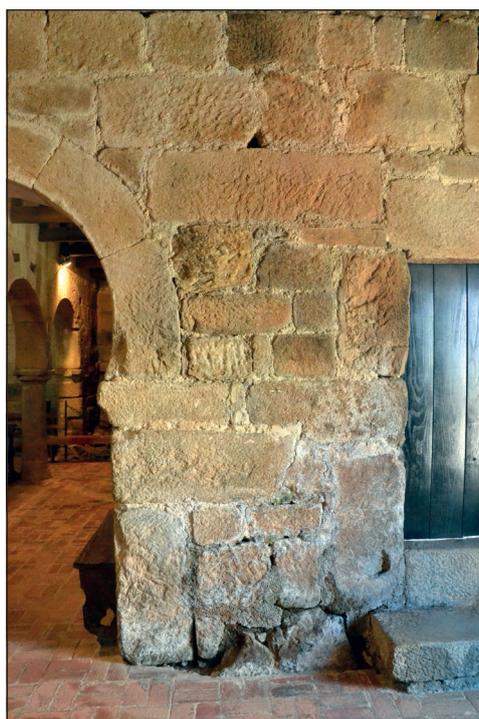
São Pedro de Lourosa. Pormenor do aparelho construtivo na câmara norte da nave transversal.
